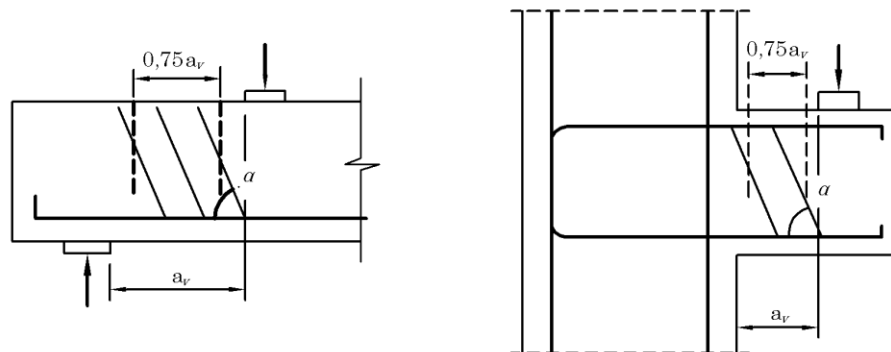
Учитываемая поперечная арматура в коротких зонах действия поперечной силы
